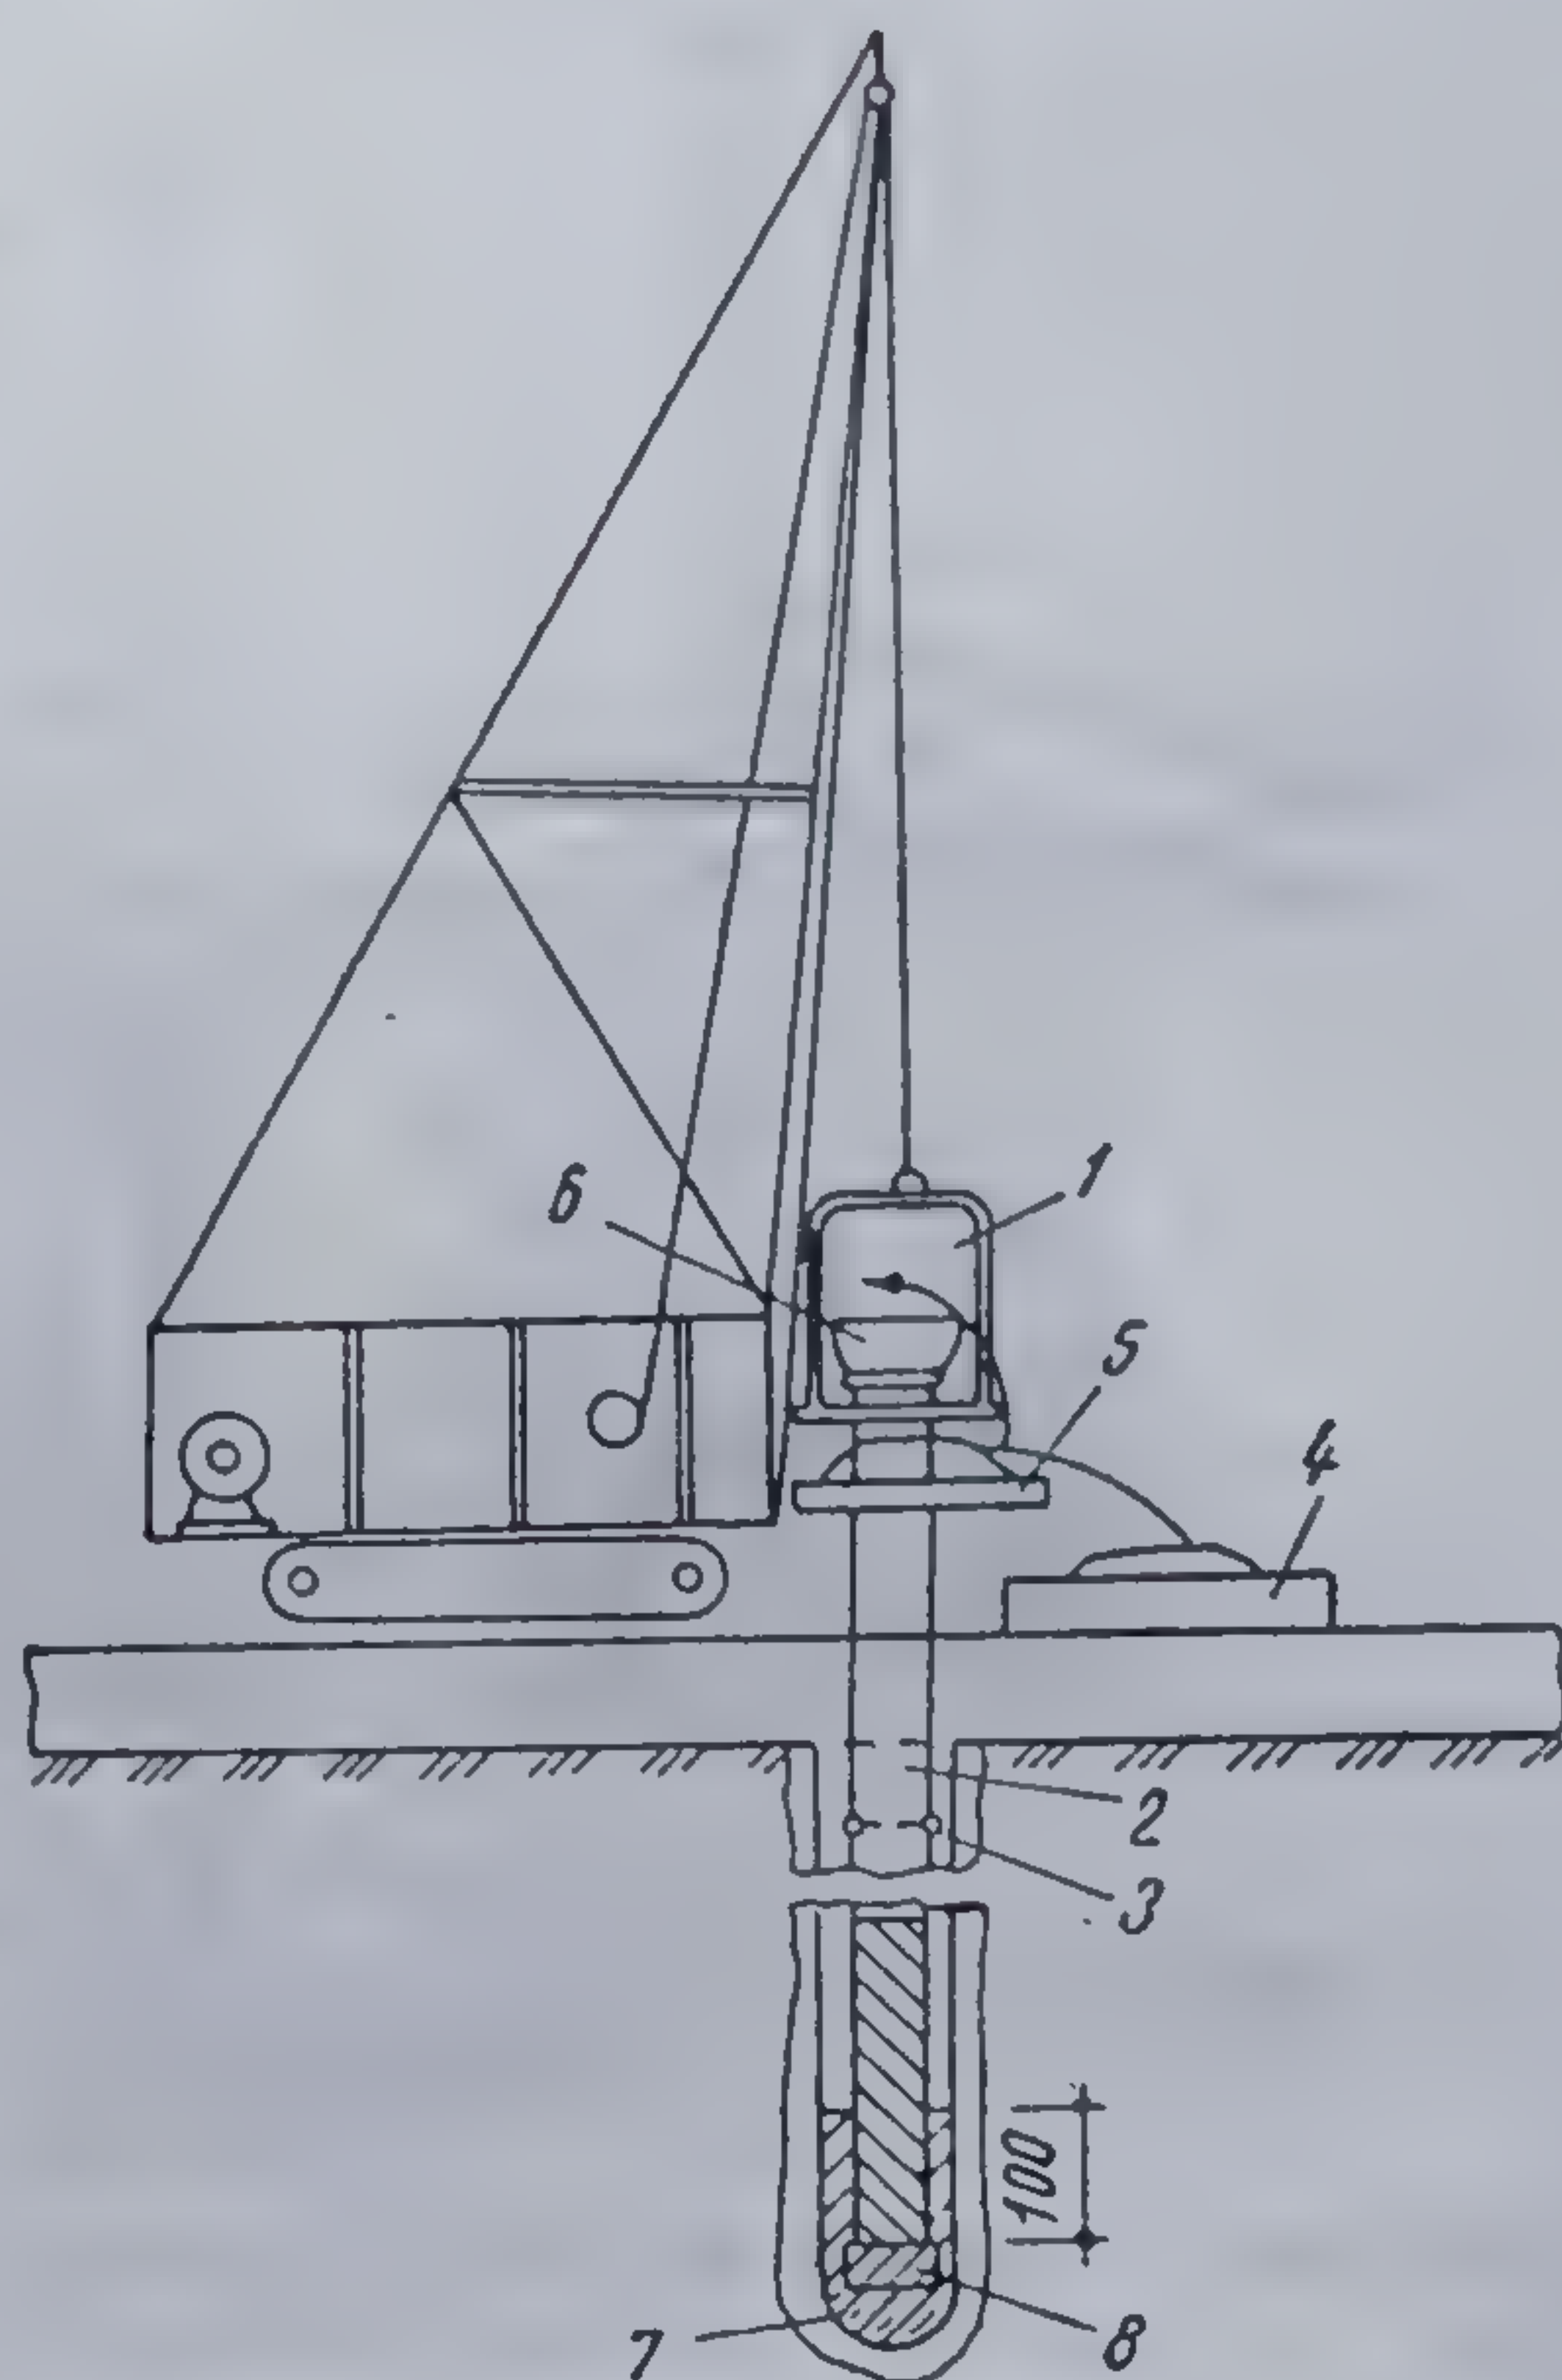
Schema instalației de betonare a pilotului secant:
